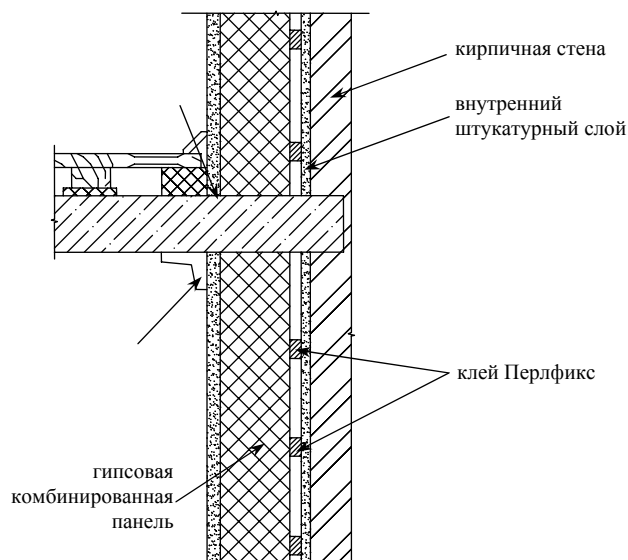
Схема утепления кирпичной стены комплексными плитами «Тиги Кнауф»
